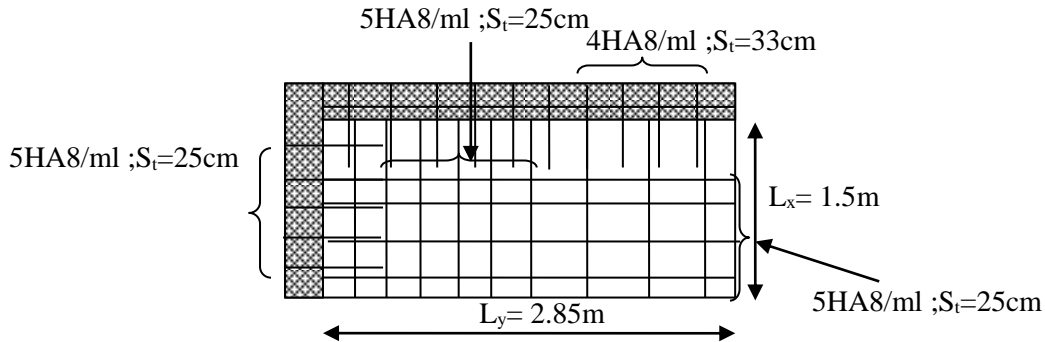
schéma de ferrailage du panneau de la dalle sur deux appuis
